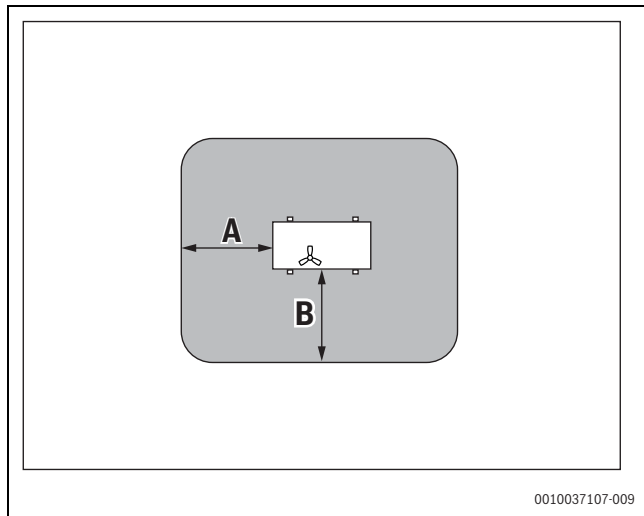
Schutzbereich bei Aufstellung auf dem Boden, auf dem Grundstück oder auf dem Dach
